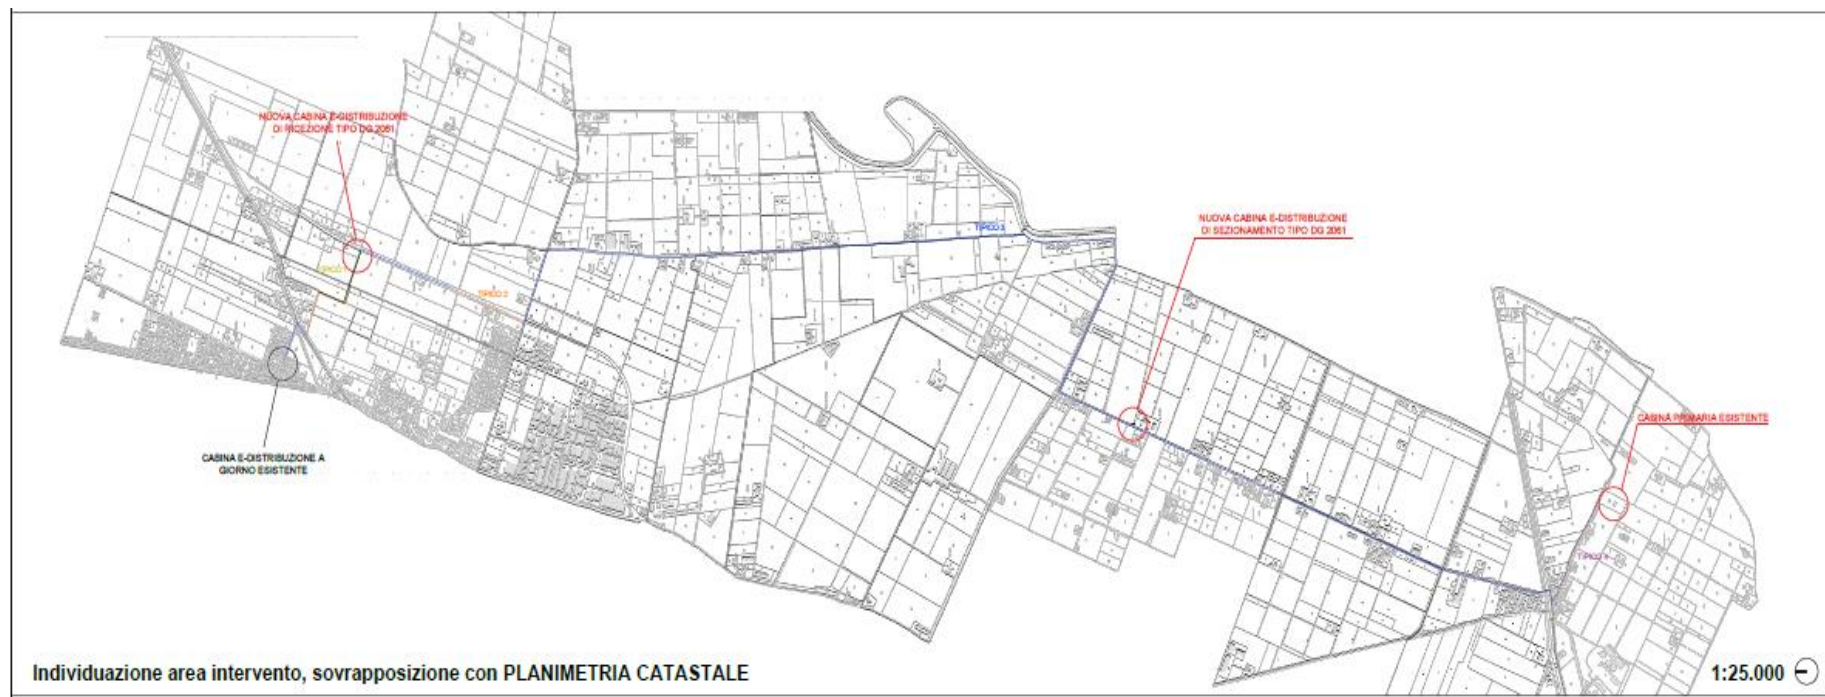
Opere di connessione su planimetria catastale (estratto TAV 3.1.1)
